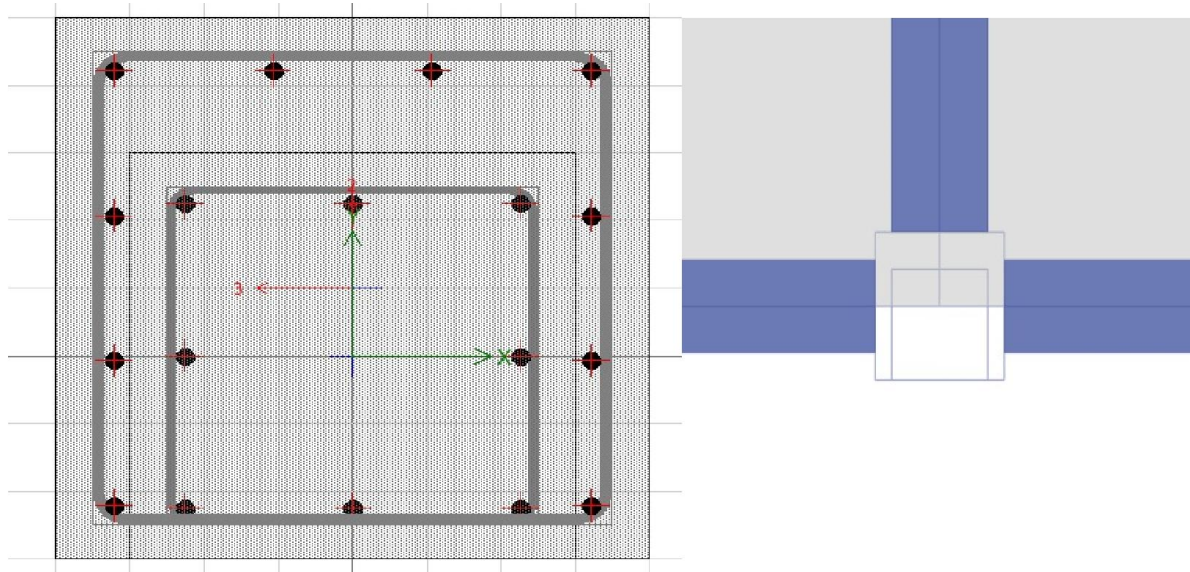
Poteaux de rive (section designer) Figure IV. 12 : poteau de rive (vue en plan)
